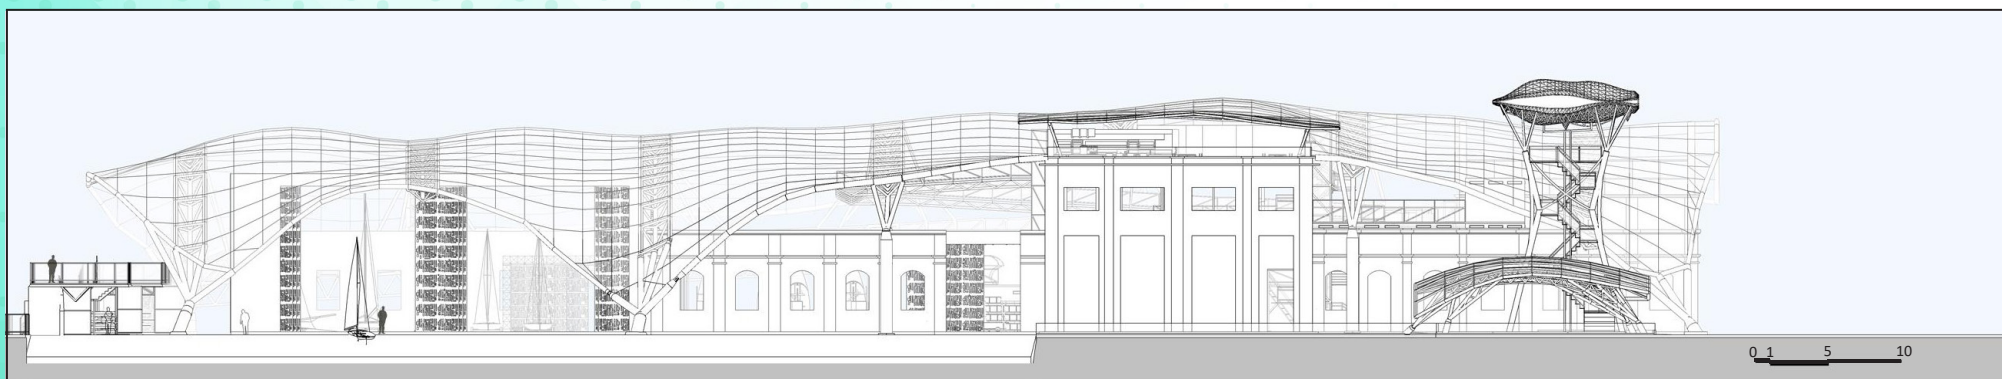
Elevação sudoeste. Planta técnica anexa em escala 1:200. Rafael Rodamilans, 2018
